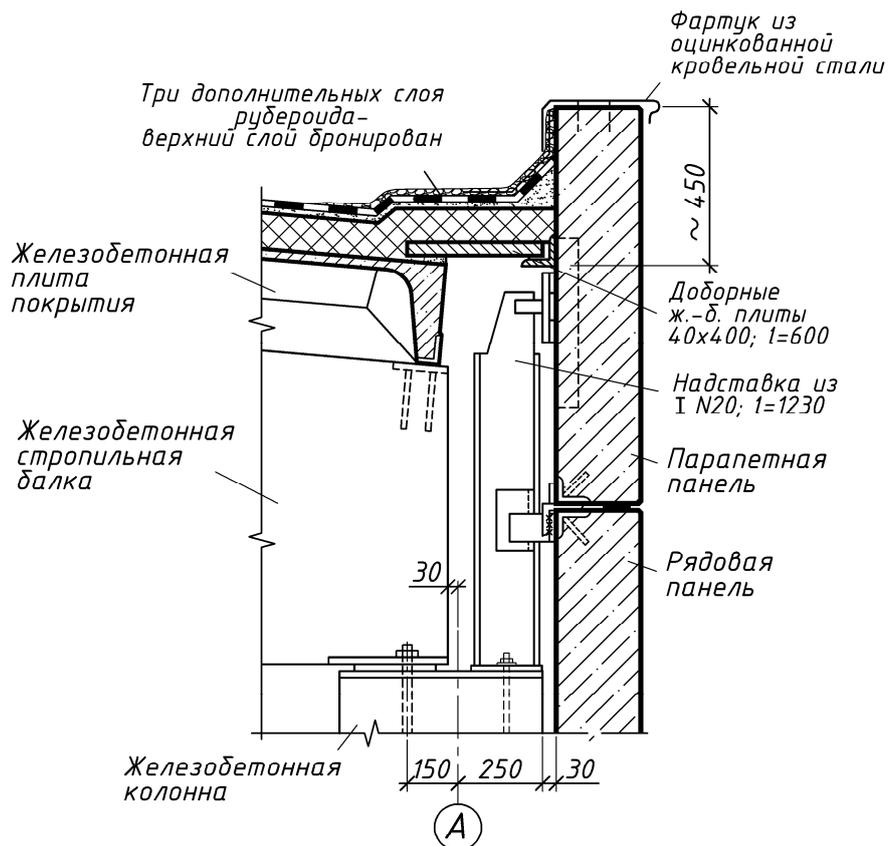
Узел опирания стропильной конструкции на колонну крайнего ряда
